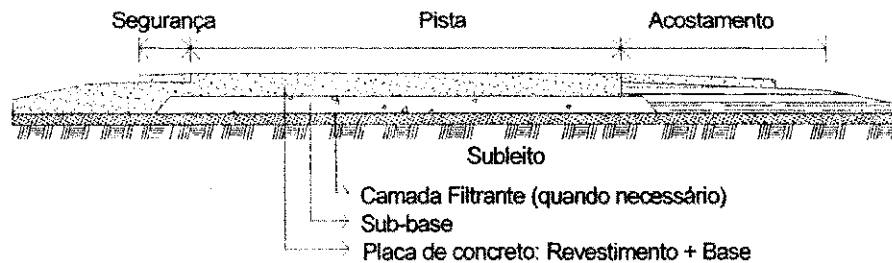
Representação esquemática das camadas do pavimento rígido.
